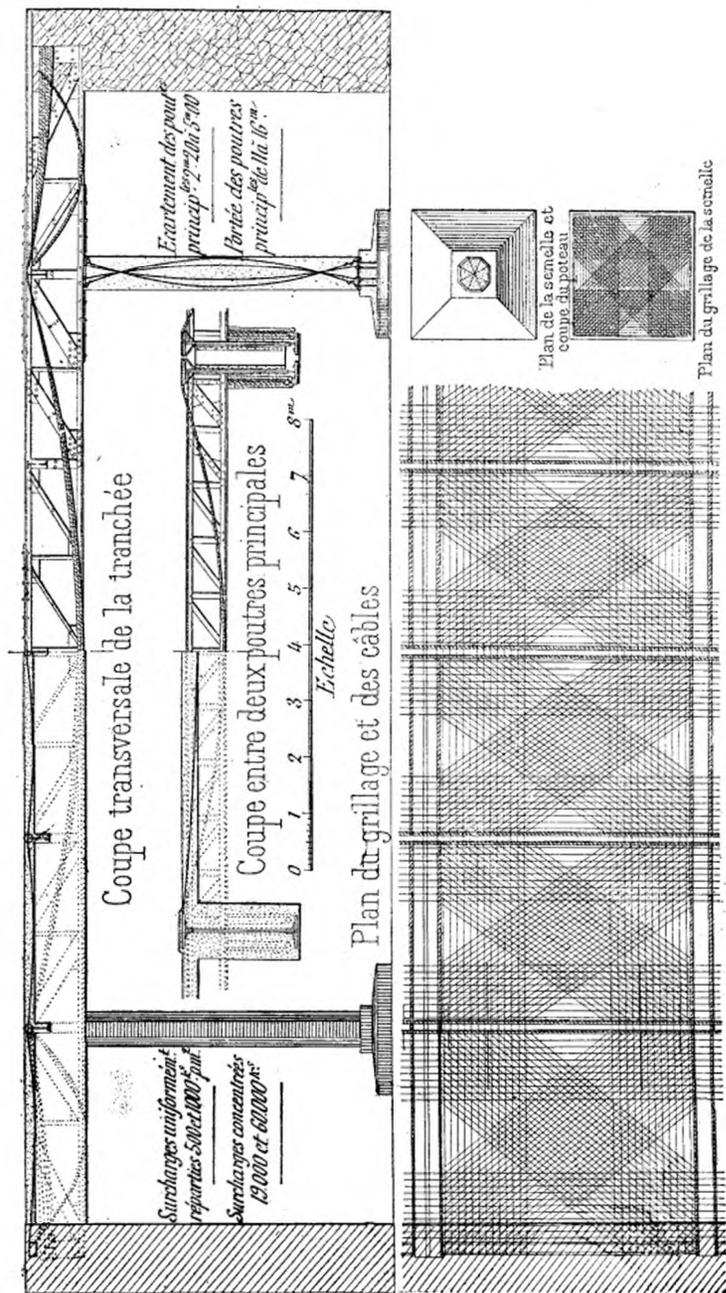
Couverture de la tranchée du chemin de fer des Moulineaux.
